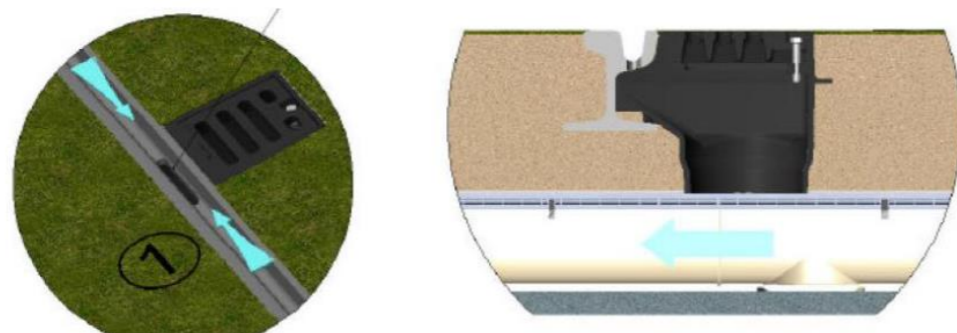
exemple d'évacuation d'eau de la gorge des rails dans une boîte de drainage
